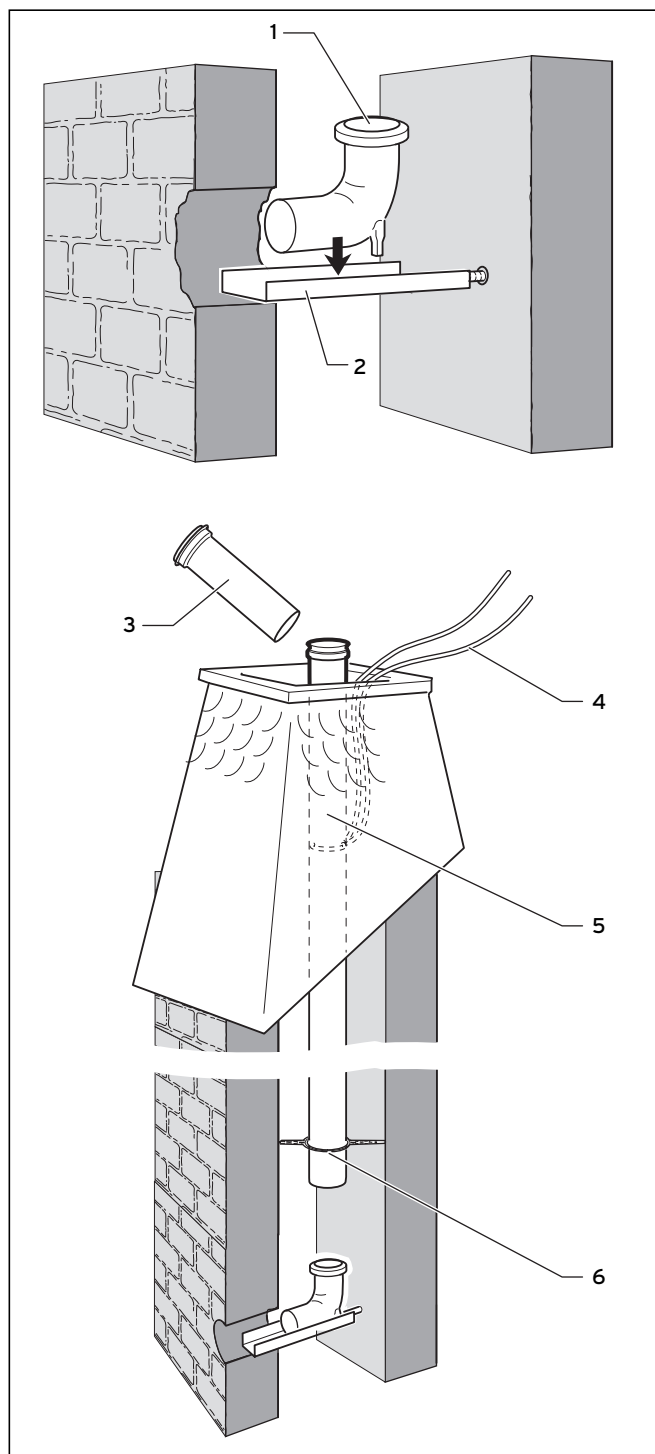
Монтаж опорной планки и отвода с опорной консолью, ввод трубы отходящих газов в шахту
